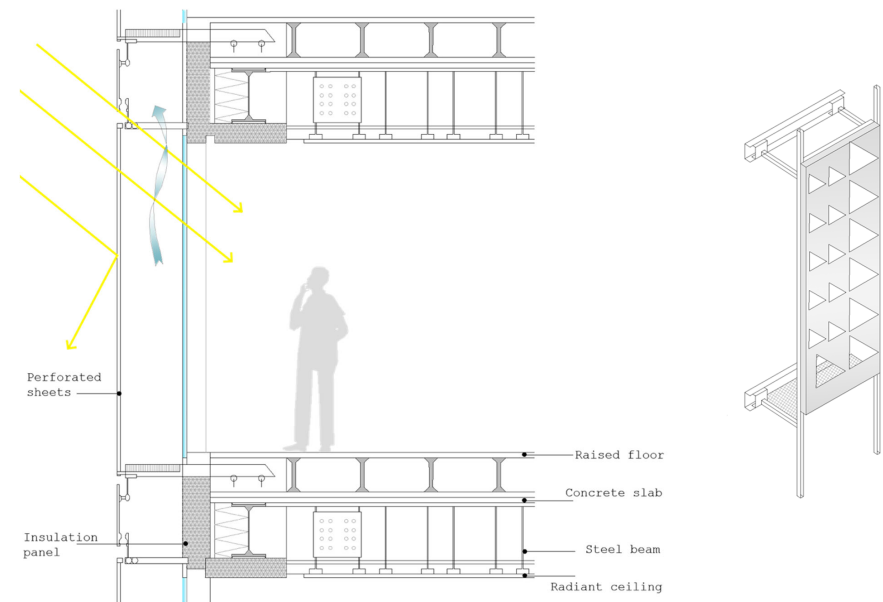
Pormenor construtivo. Fonte: Autora
